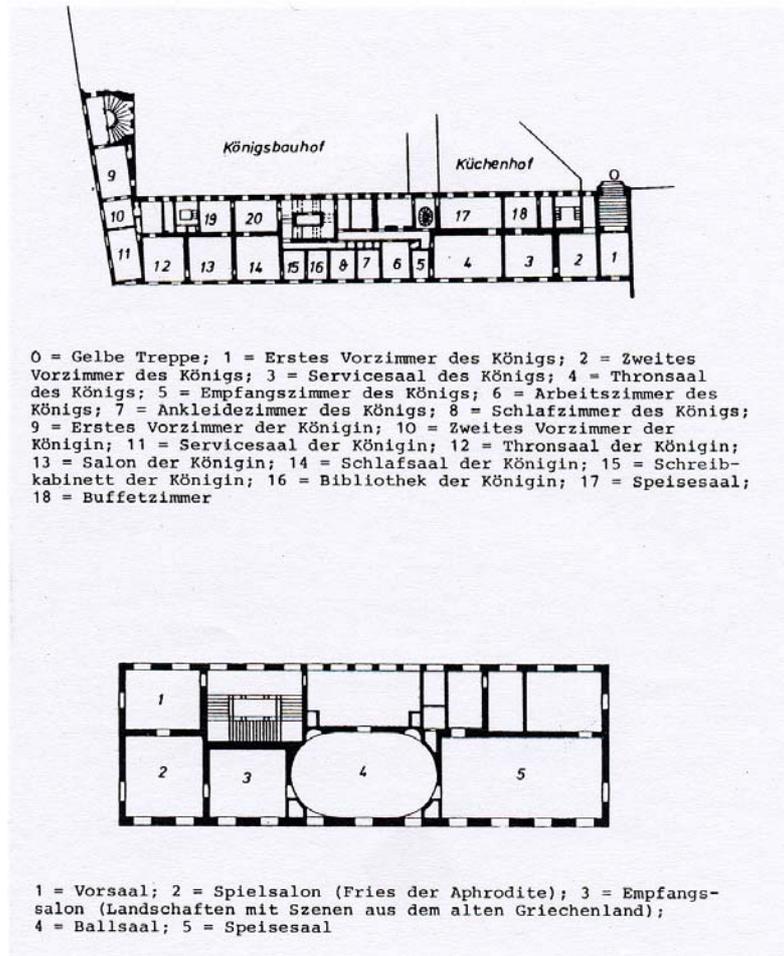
Schematischer Grundriss des ersten und zweiten Obergeschosses, Königsbau, Münchner Residenz
